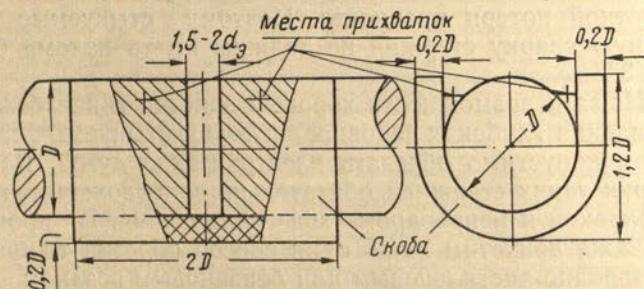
Горизонтальный стык стержней, подготовленных к ванной сварке
